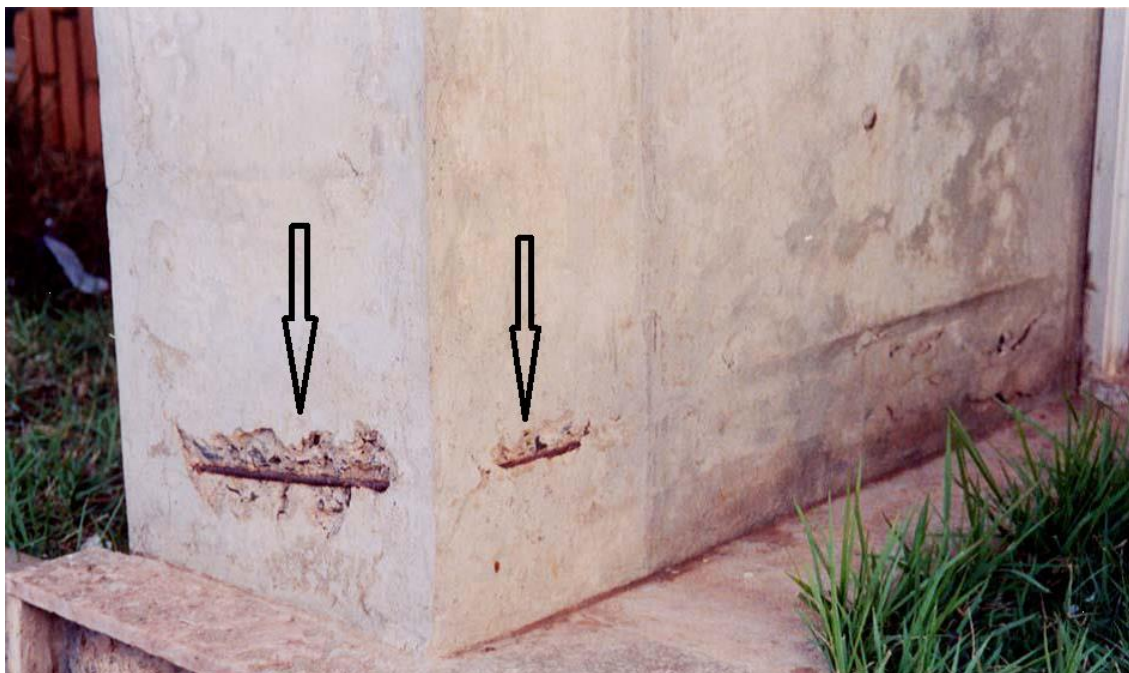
Pilar com estribo Exposto (II). Fonte: autores.
